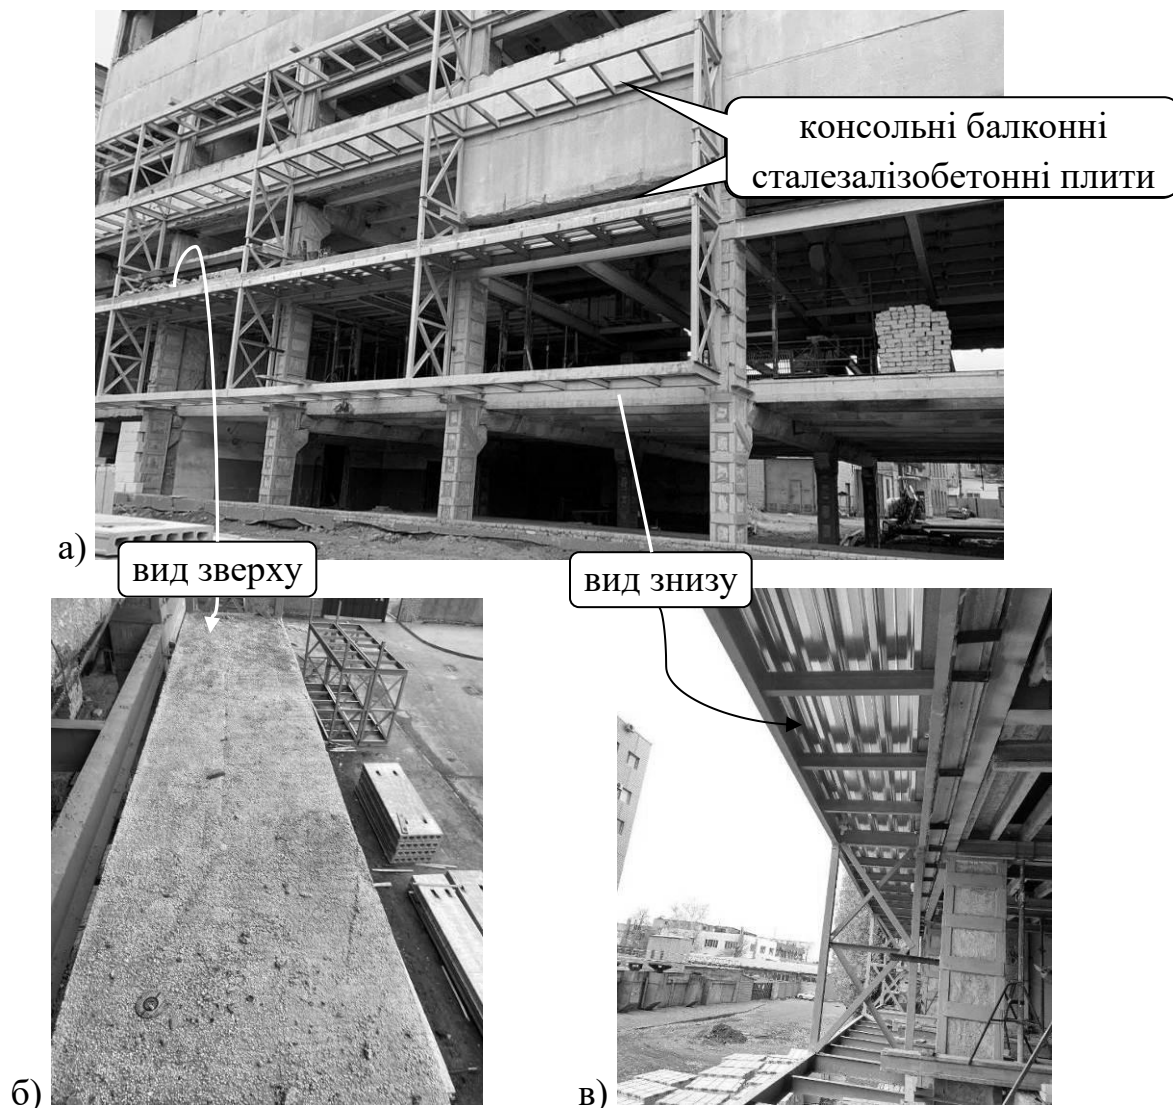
Загальний вигляд консольних балконних плит, сталезалізобетонна монолітна плита яких влаштована по балковій клітці із холодноформованих профілів: а) загальний вид фрагменту фасаду будівлі під час реконструкції; б) вид зверху на монолітну бетонну плиту; в) вид знизу на профільований настил незнімної опалубки та елементи сталевої консольної балкової клітки
